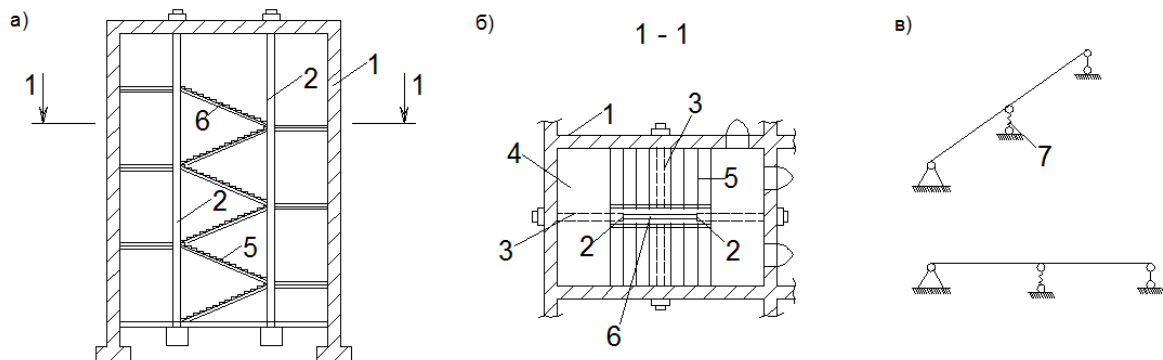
Сейсмоусиление лестничной клетки решетчатой диафрагмой жесткости. а - общий вид разреза усиленной лестничной клетки; б – план лестничной клетки по 1-1; в – расчетные схемы лестничных маршей и площадок; 1 – стена клетки; 2 – стойки усиления; 3 – анкерные тяги; 4 – площадка; 5 – лестницы; 6 – раскос фермы; 7 – упругие опоры
